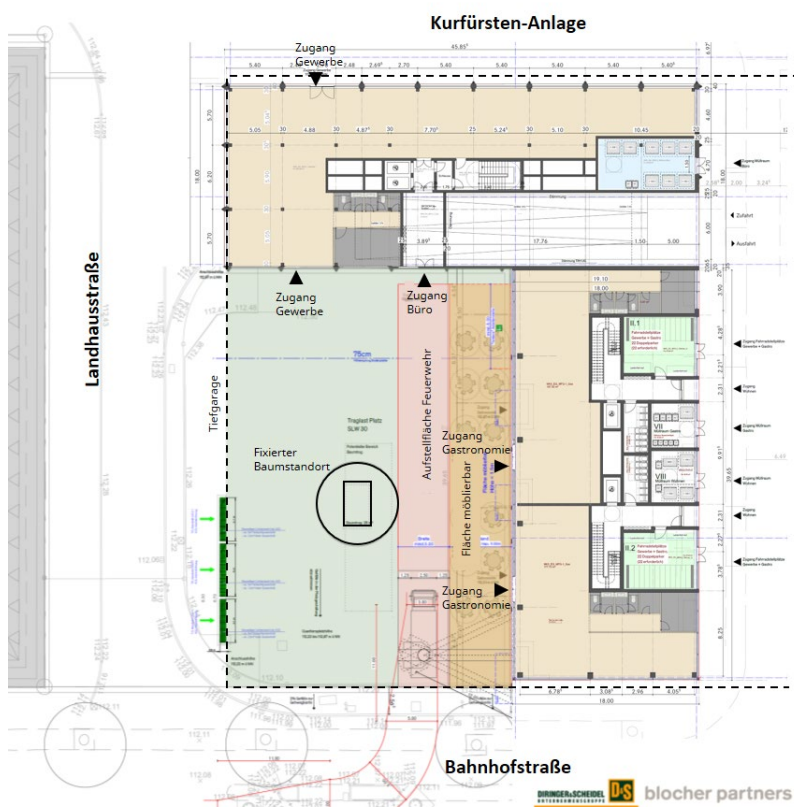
Plangebiet mit Kennzeichnung der Fixpunkte
